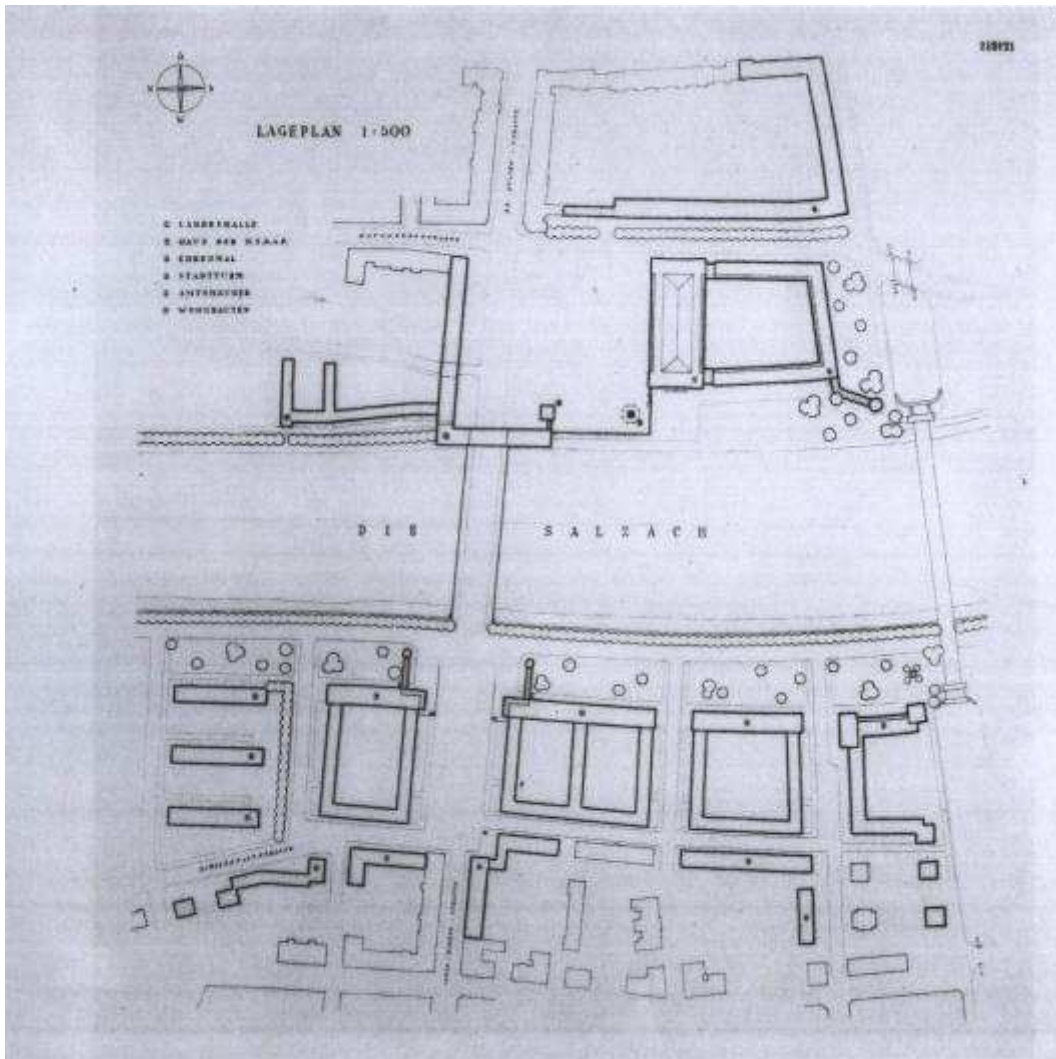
Büro Prossinger, Lageplan, Wettbewerb Gestaltung der Brückenköpfe an der Ludwig-Viktor-Brücke (Lehener Brücke), Salzburg, 1939 (AzW, Nachlass Spalt).
